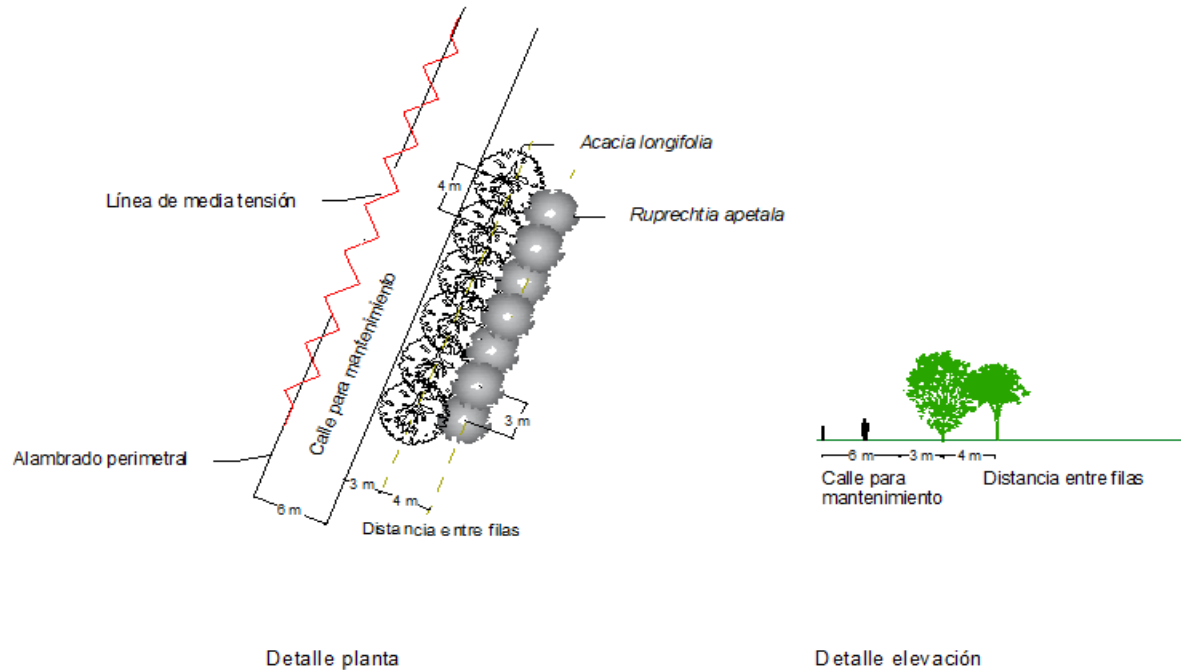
Detalle de plantación Tramo B – Sector Oeste y NorOeste
